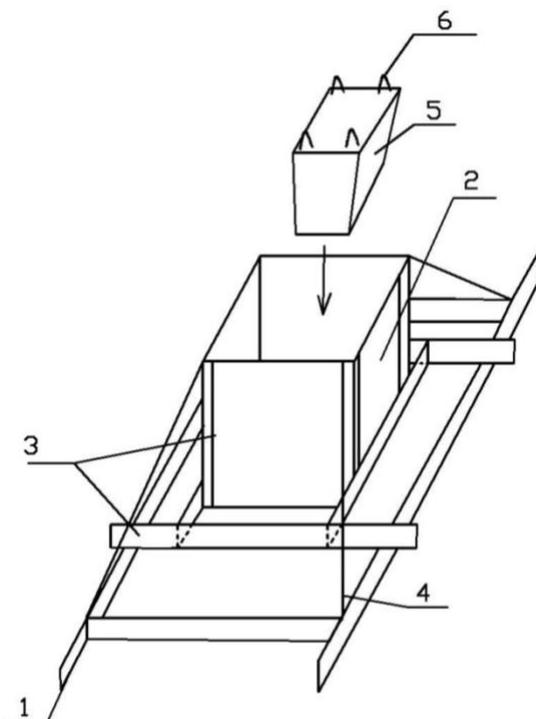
Блок-форма для бетонирования монолитного фундамента под колонну:
